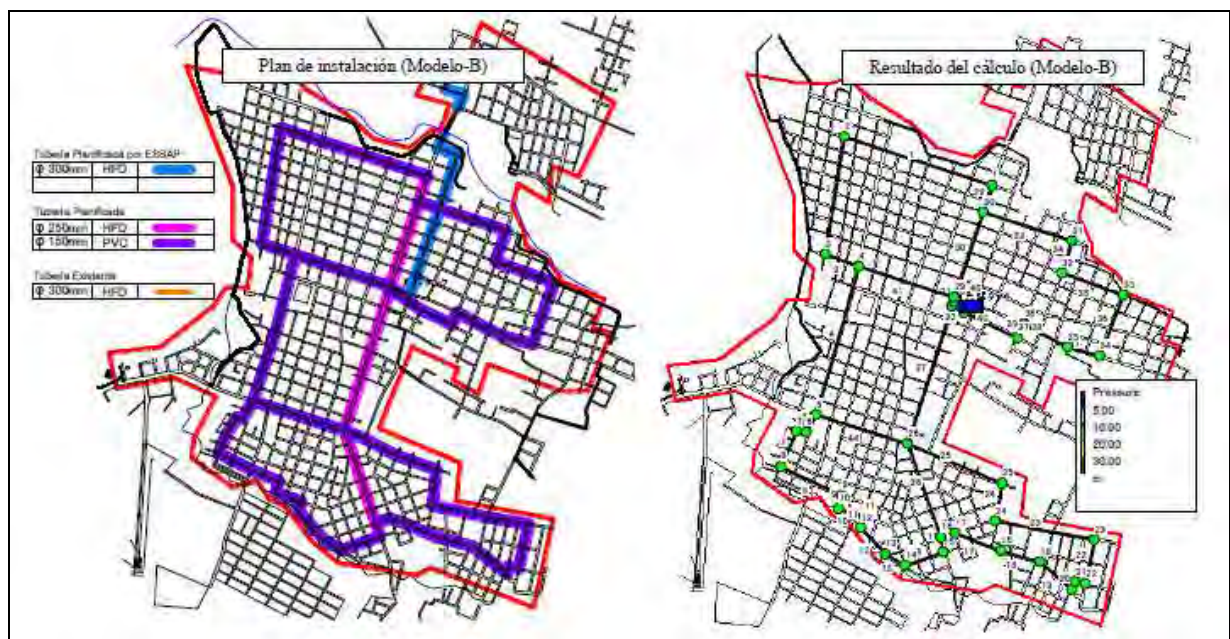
Plan de optimización de las redes de distribución en la ciudad de Pilar
